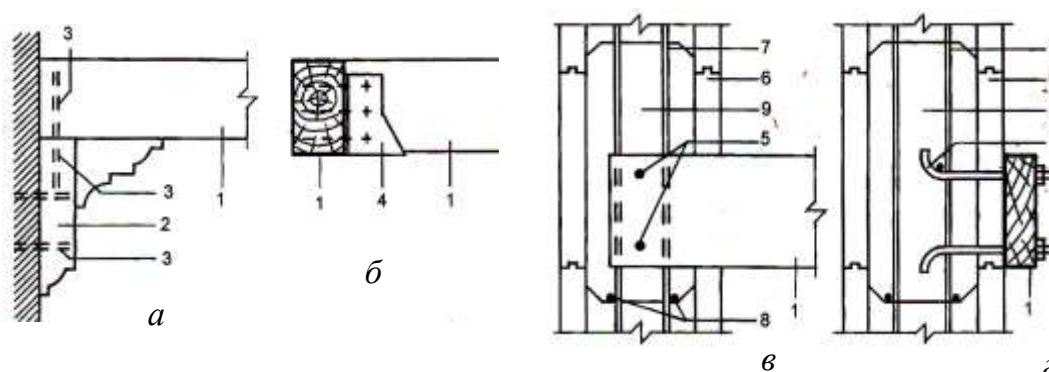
Спирання дерев'яних балок перекриттів на зовнішні стіни:
